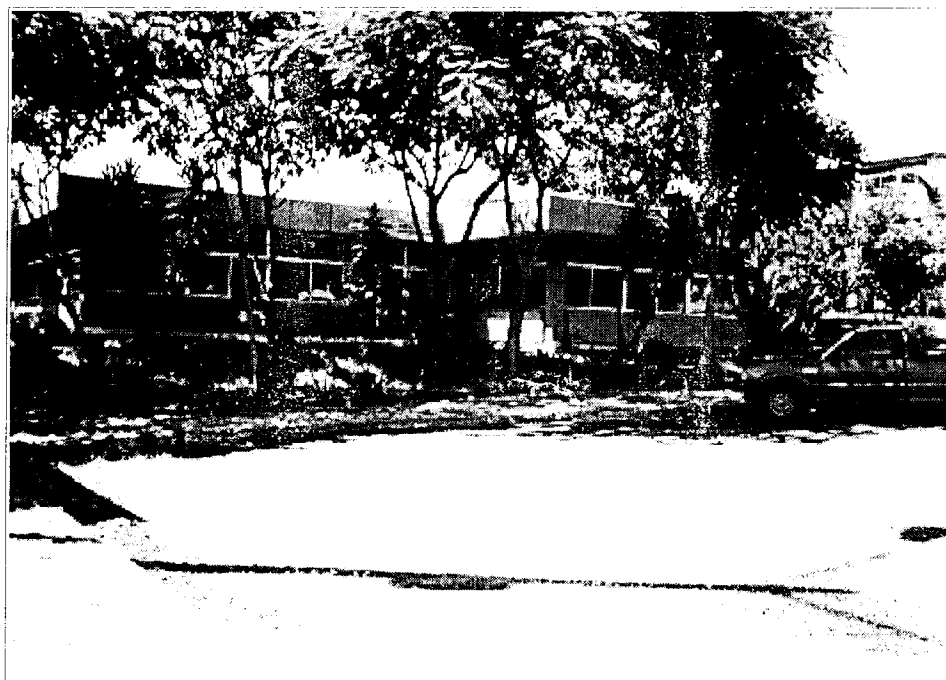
Laboratorios F.I.C.T.:* Geología: puerta metálica enrollable, bajantes AA.LL.
